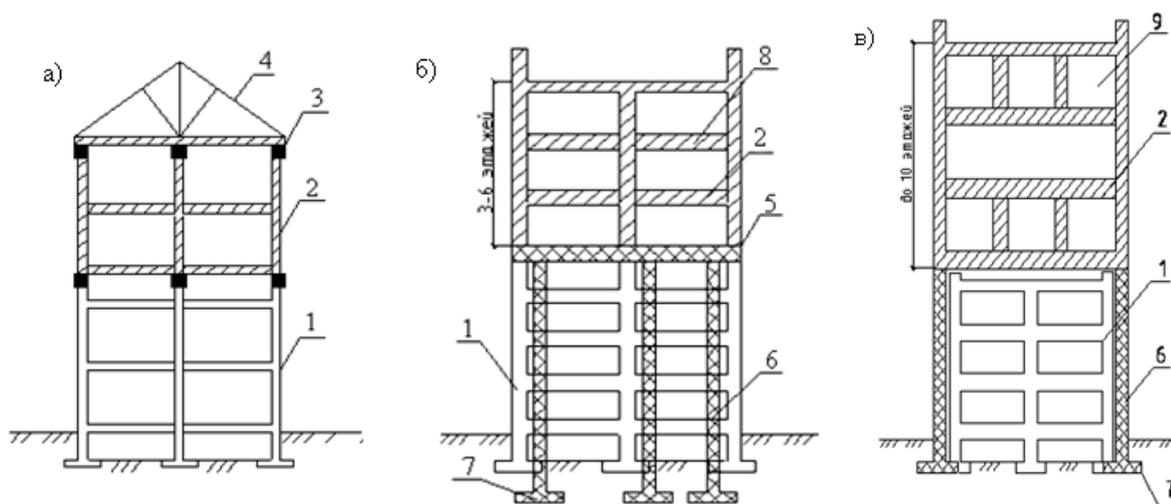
Схемы надстройки зданий при реконструкции:
